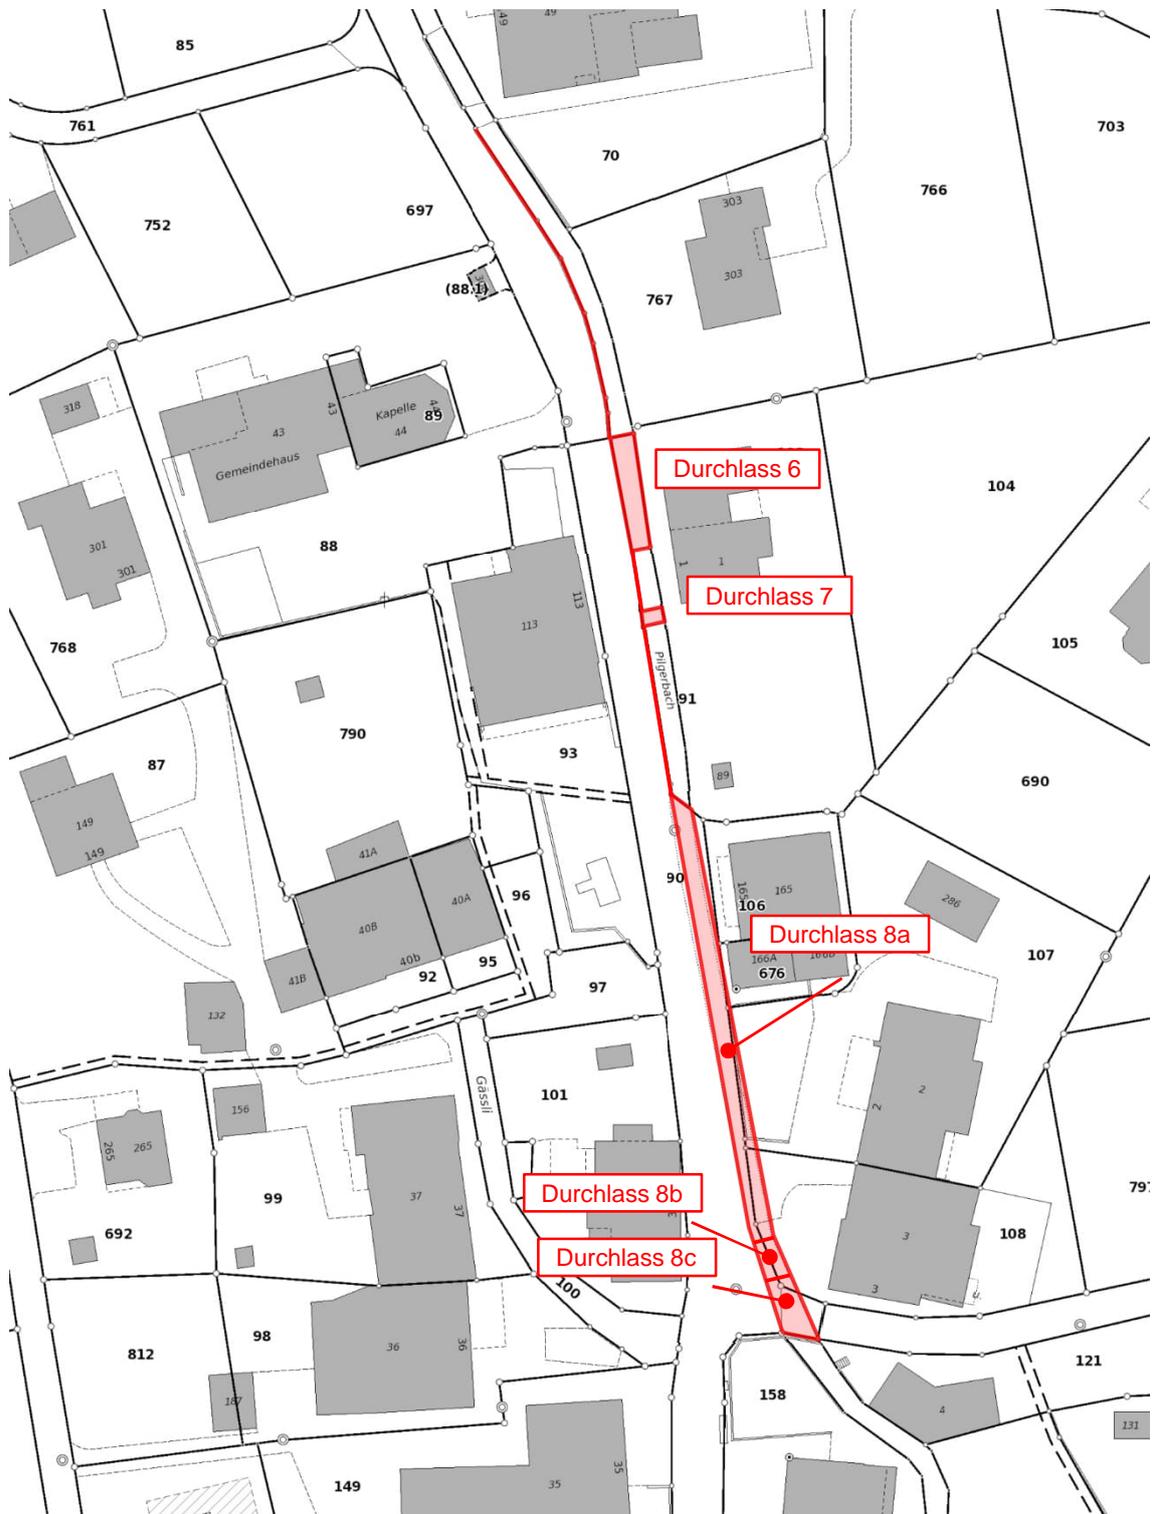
Lageplan mit Objektbezeichnungen (Teil 2/3)
